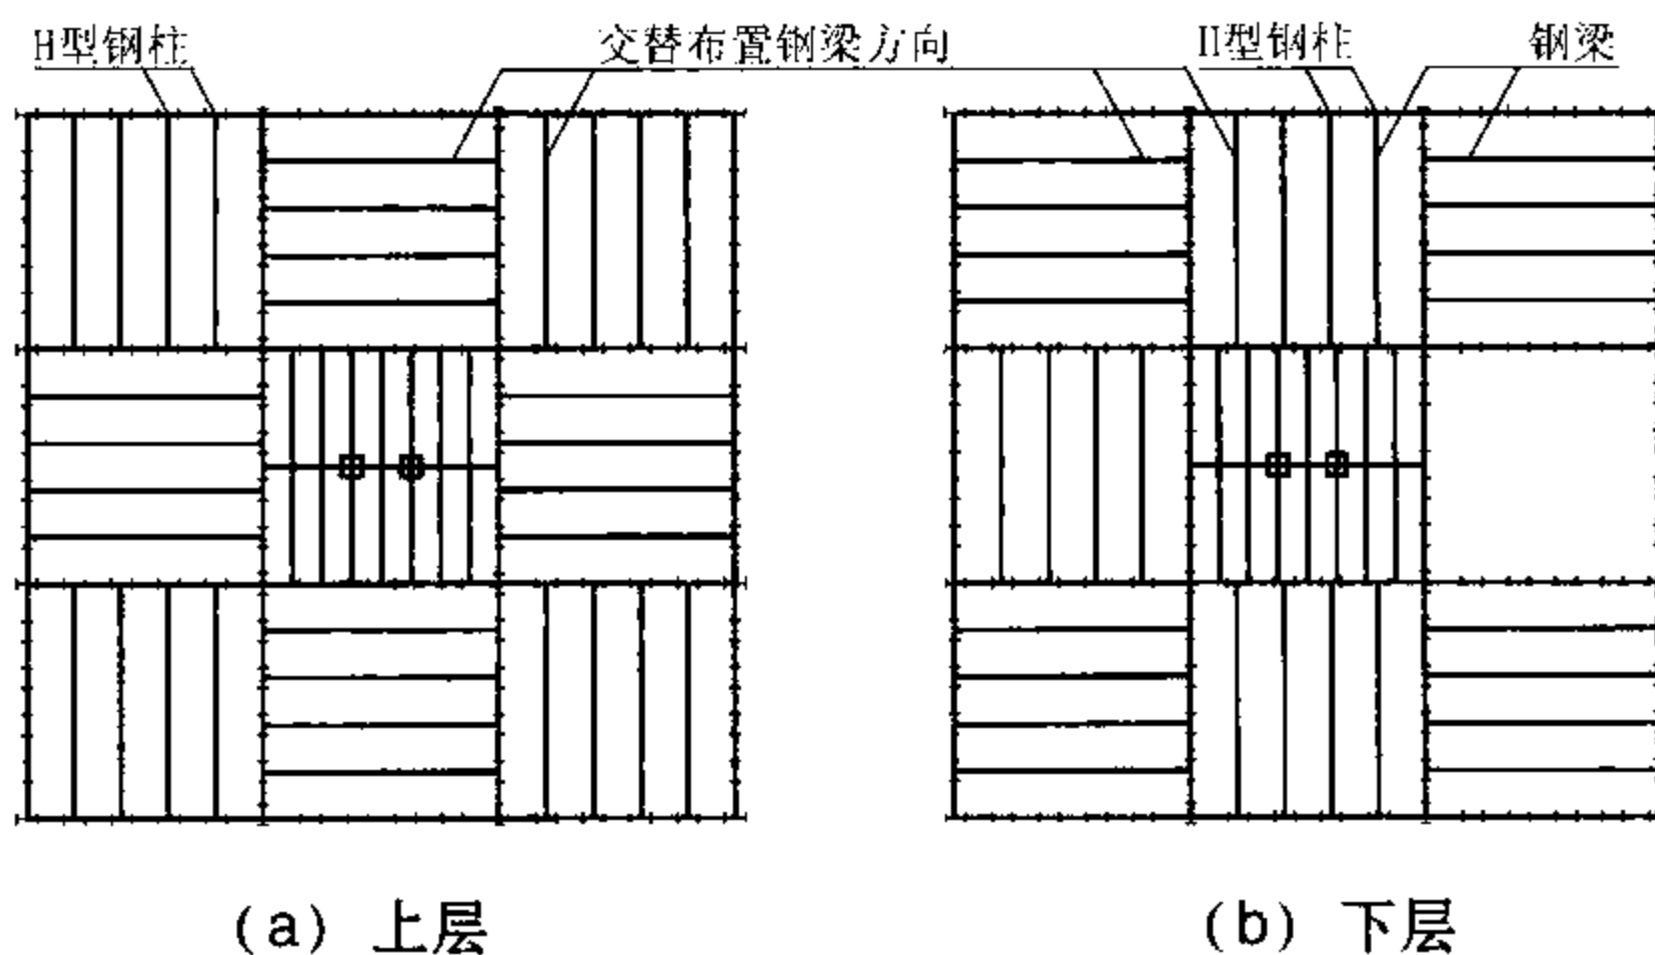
框筒束体系上、下层楼面钢梁方向的交替布置图
